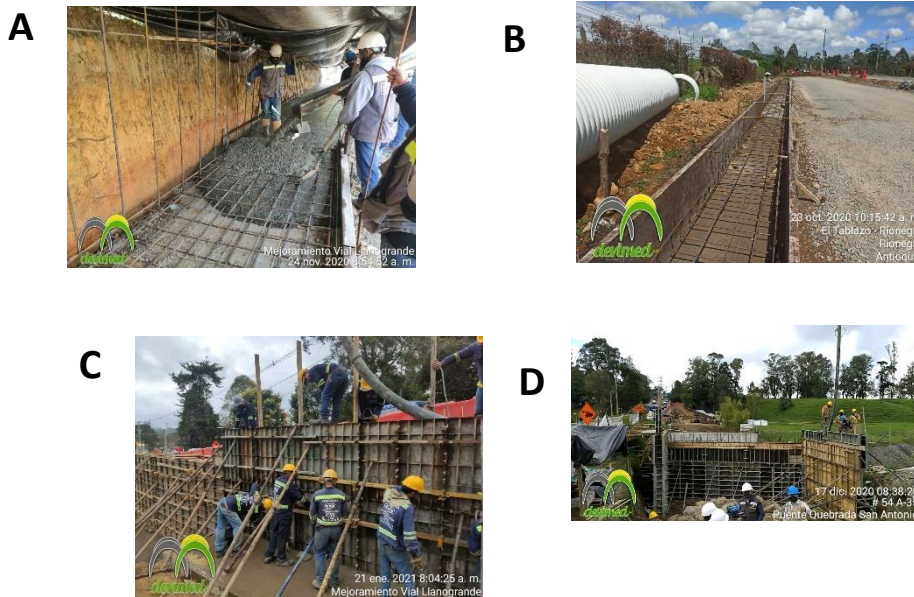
Obras complementarias. a Los andenes no son obras estructurales, pero se requiere supervisión en la construcción para garantizar durabilidad y acabados. b Dentro de las obras de drenaje realizadas en obra se encuentran las cunetas, canales, box culvert e instalación de tuberías para drenaje. c Los muros de contención en la obra no son muchos, pero por ser obras estructurales requieren del seguimiento y ensayos de resistencias tanto en obra como los de la planta de concreto. d Los puentes a construir en la quebrada San Antonio y en Río Negro son grandes hitos en la obra por lo que se les presta gran atención en la calidad y acabados.
